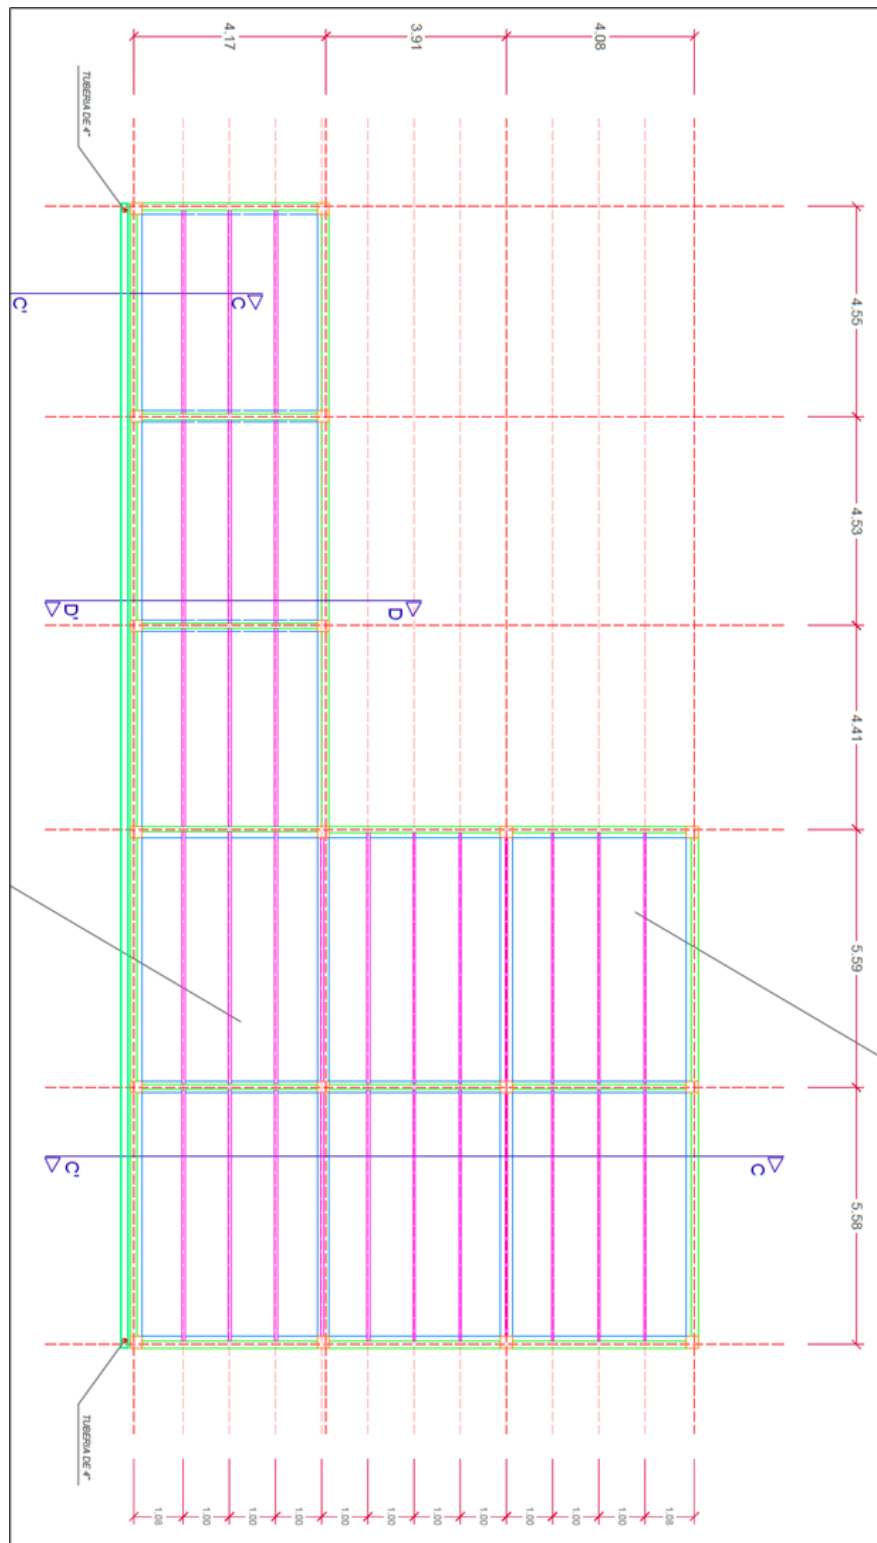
Vista en planta de entramado de perfil de acero de la estructura 3 del Centro Vida.
